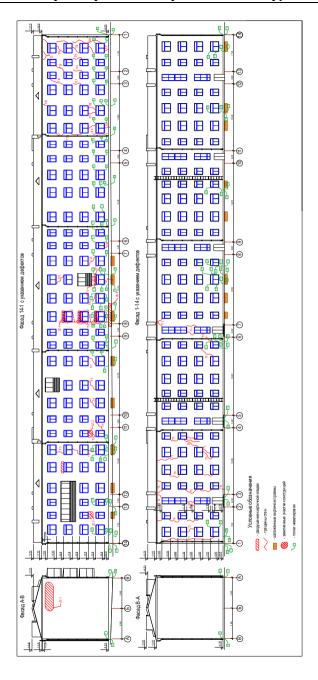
Фасады здания по ул. Свободы, 17 с указанием дефектов
